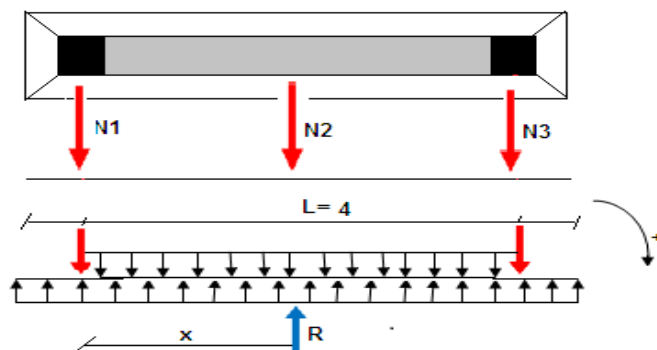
schéma statique de la semelle filante sous deux poteaux et un voile
